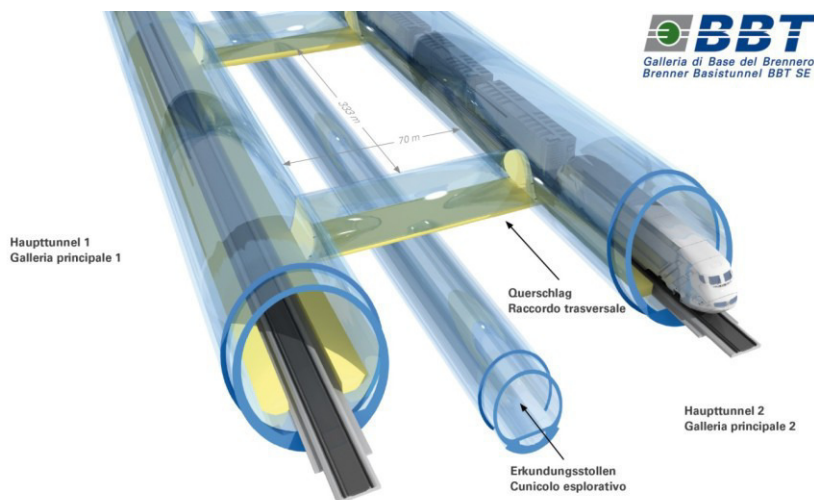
Ansicht der Haupttunnelröhren mit Erkundungsstollen und Querschlägen [5]
